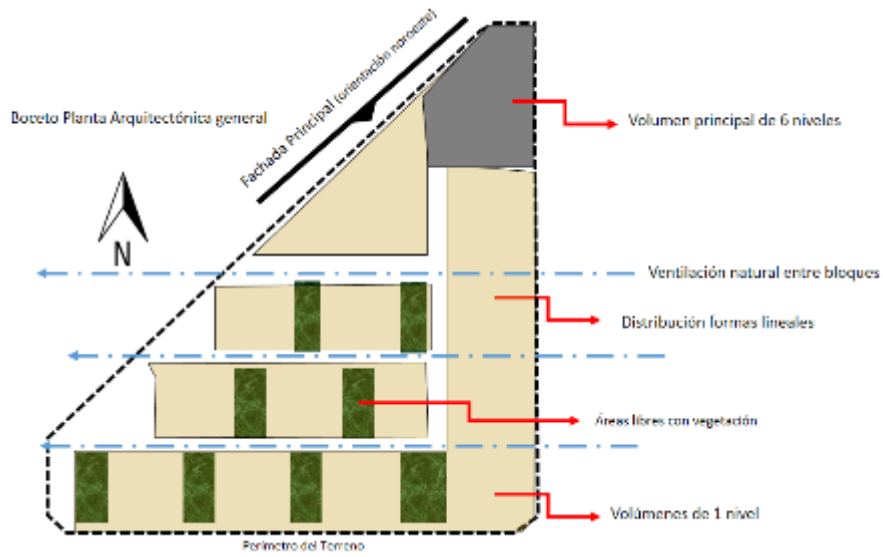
Boceto planta arquitectónica caso 2. Fuente: Elaboración propia
